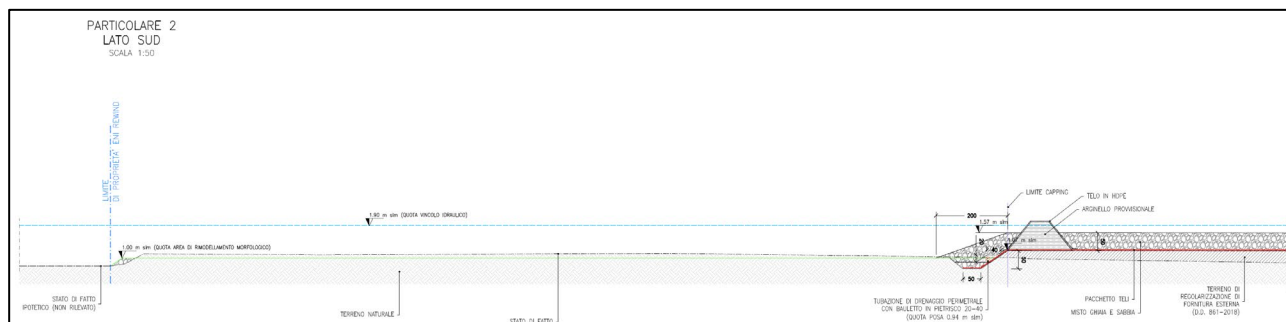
Stralcio sezione stato atteso ad inizio del cantiere
